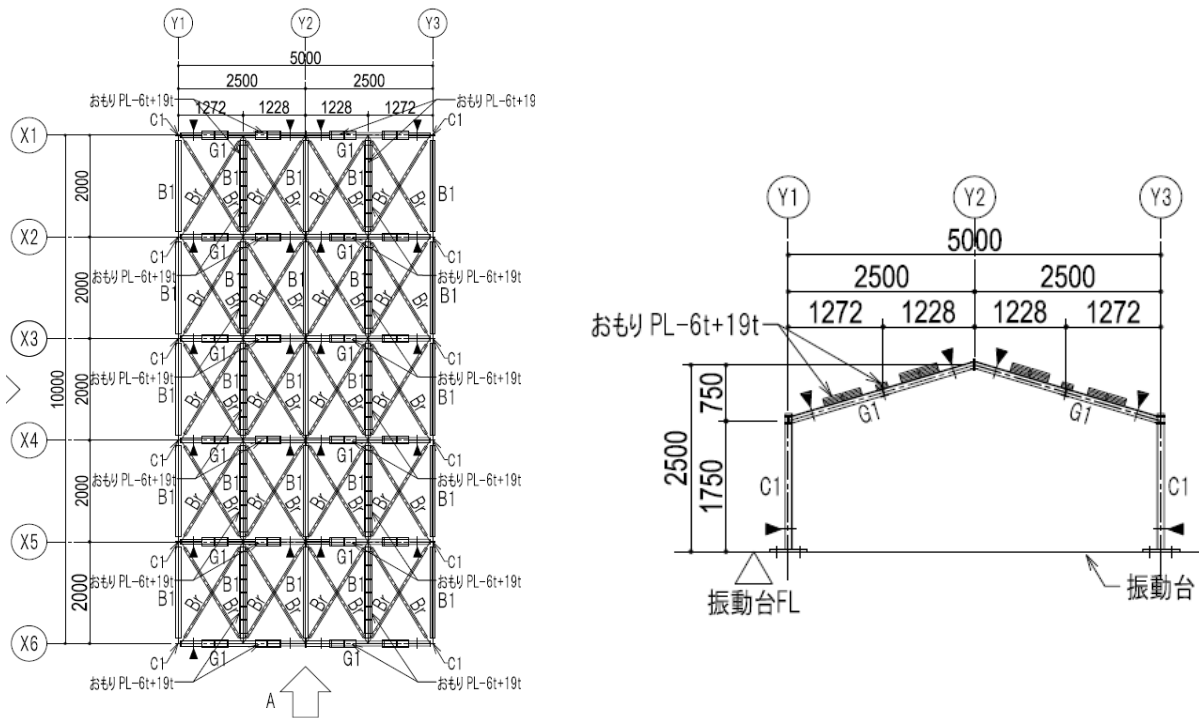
試験体平面図 (左) と A 矢視立面図 (右)
